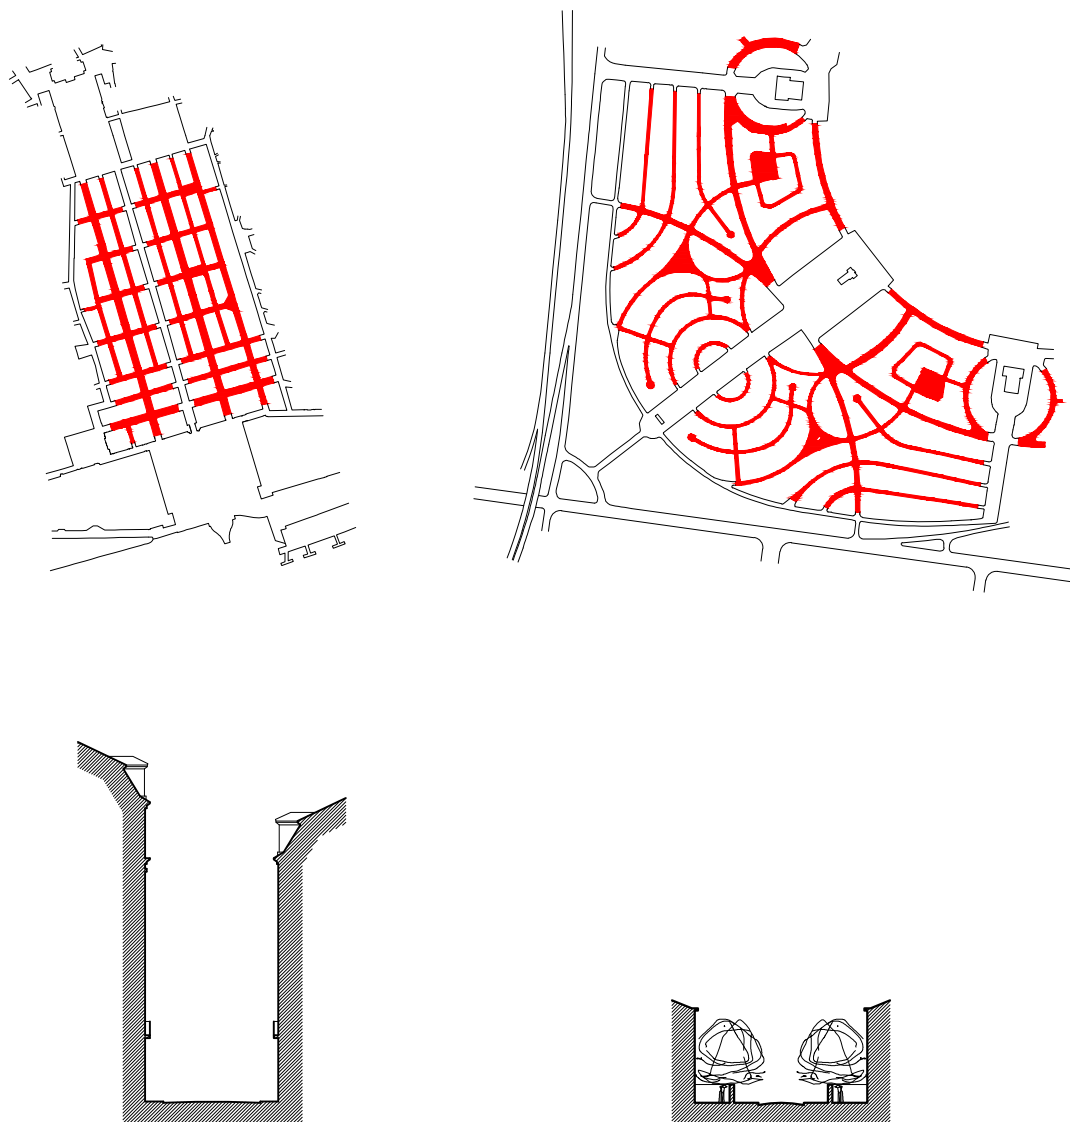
• Ruas de iniciativa pública - Ruas de urbanização. Traçado (1:15.000) e secções transversais-tipo (1:500).
